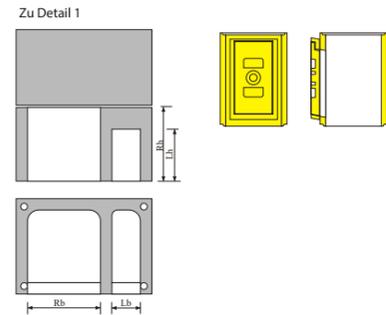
Grundriss und Schnitt Reinigungs- und Kontrollverschluss rundeinlass
